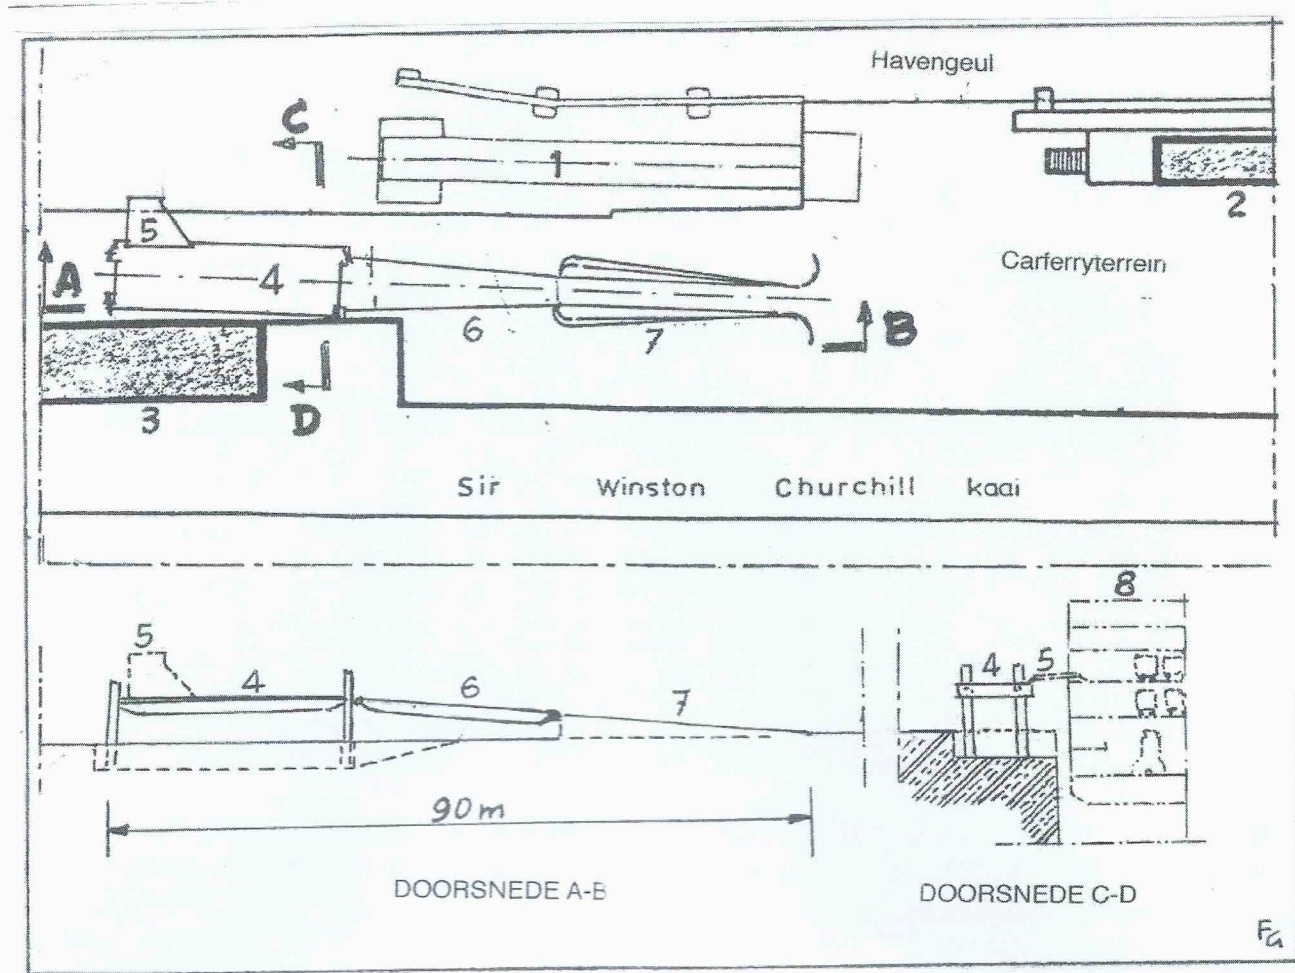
Haven Oostende, 1984. Pakketbotenkaai (Londen-Istanbulkaai). Situatieplan van de zijlaadinstallatie van carferrybrug 1.
